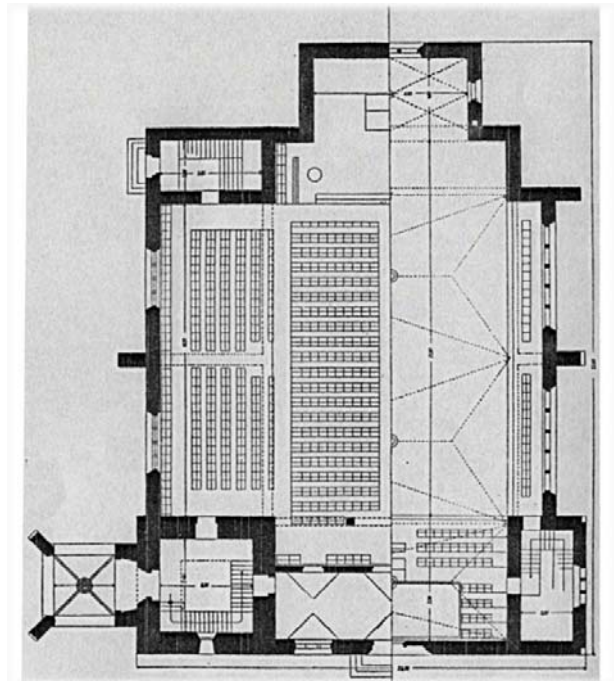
Grundriss Erd-/Emporengeschoss
